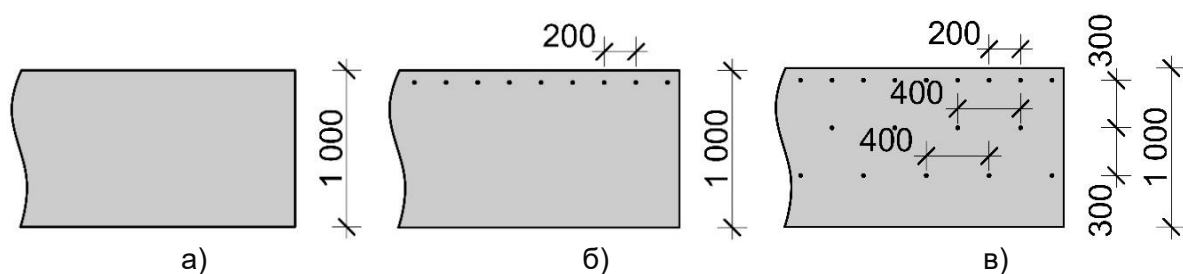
Схема расположения подкладочного ковра Döcke.
